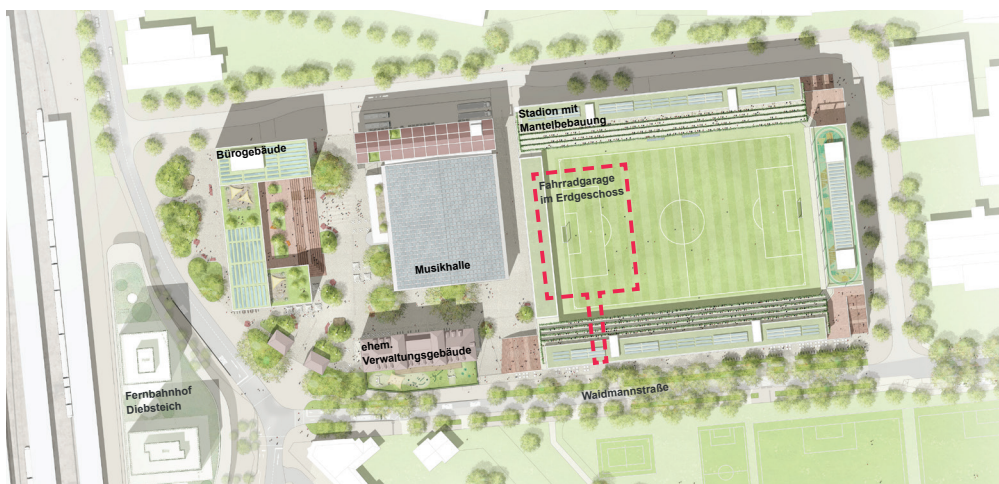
Lageplan Fahrradgarage. Quelle: GMP
